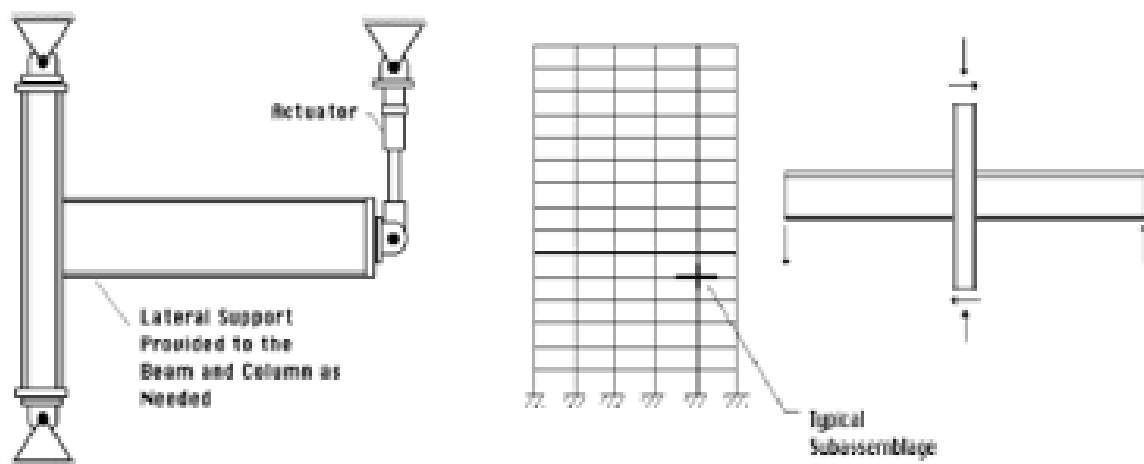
Esquema de ensayo para el proceso de calificación de una conexión viga-columna, FUENTE: FEMA 355 D
